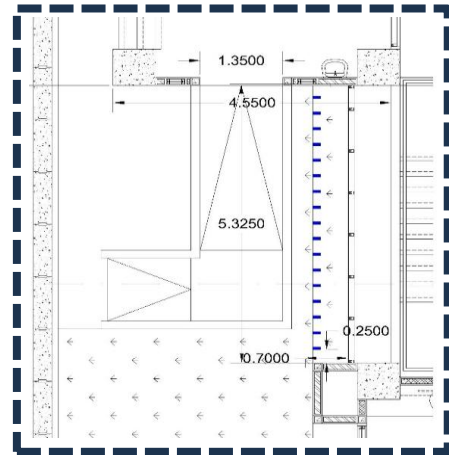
Denah Ruang baca sisi timur Gedung Auditorium
